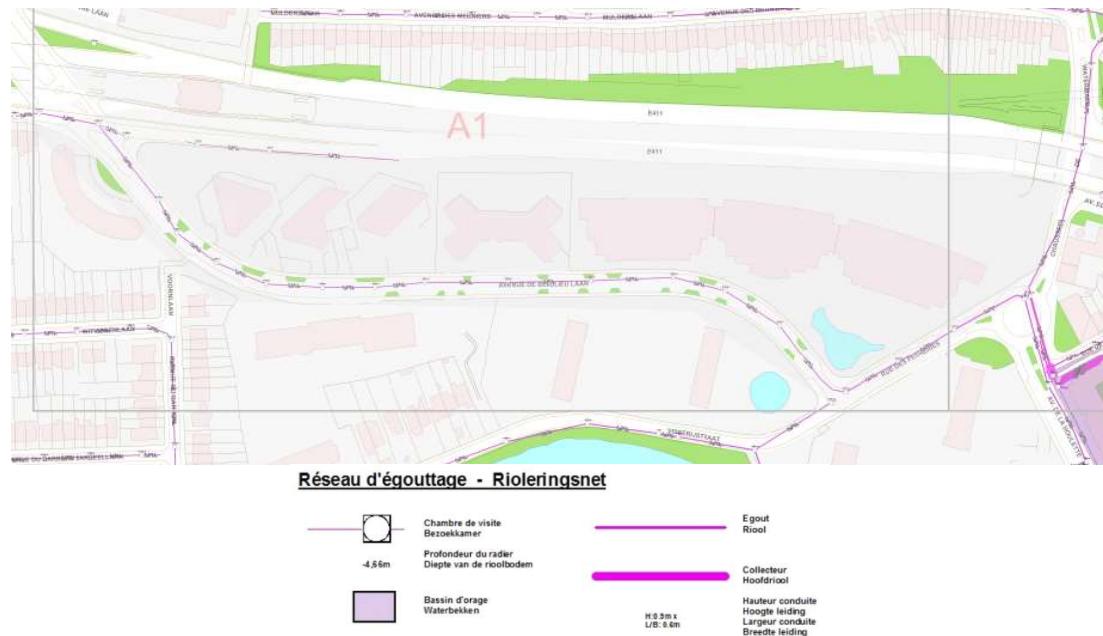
Egouttage à hauteur du site Beaulieu (VIVAQUA, mars 2018)
